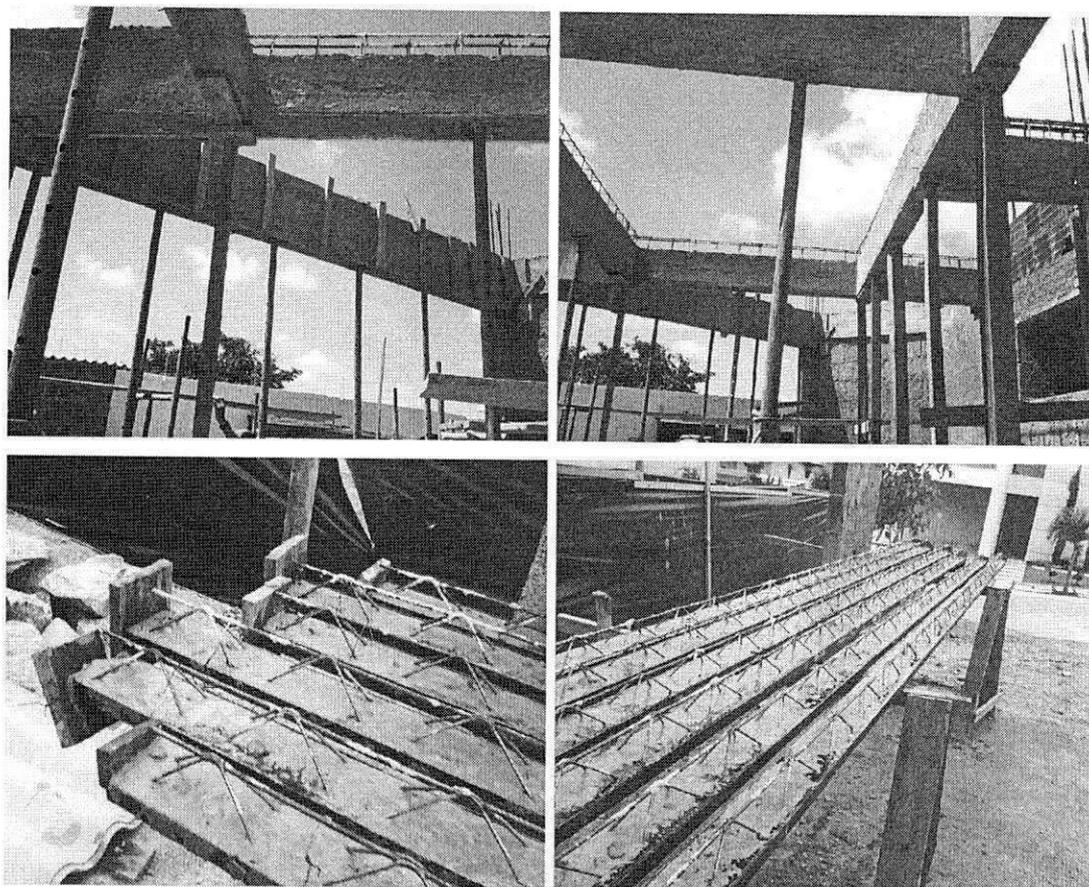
a 71 – Aplicação do chapisco, colocação das ferragens e das fôrmas das vigas, concretagem e confecção das vigotas das lajes
